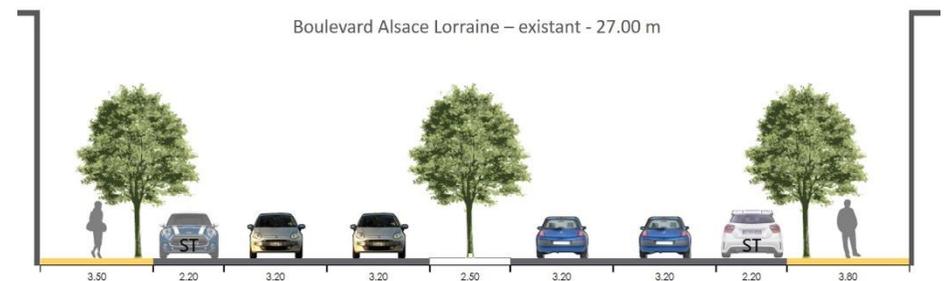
Coupe 2-1 actuelle - boulevard Alsace Lorraine
